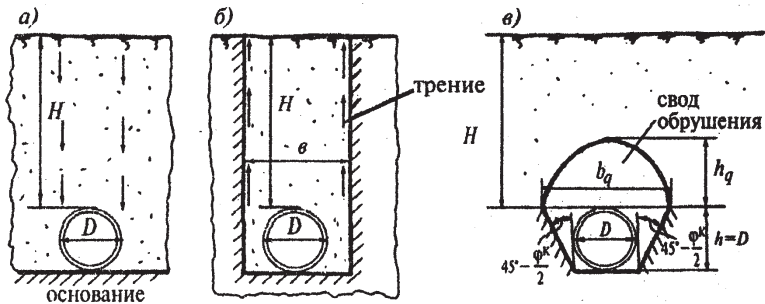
Расчетные схемы определения грунта на трубопровод:
